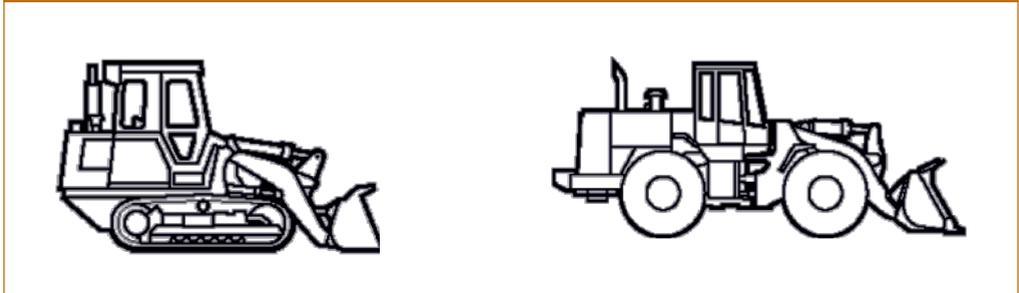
Escavatore su cingoli (sinistra) e escavatore su ruote (destra)
